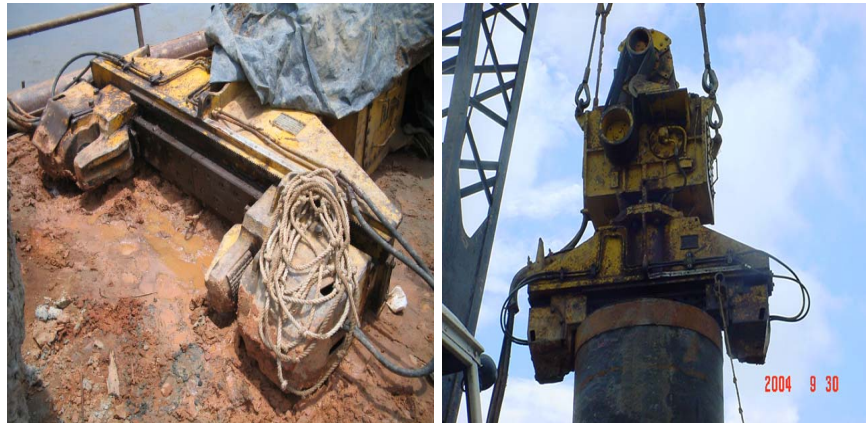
y 7. Piloteadora excavando el suelo. Extracción del material.
